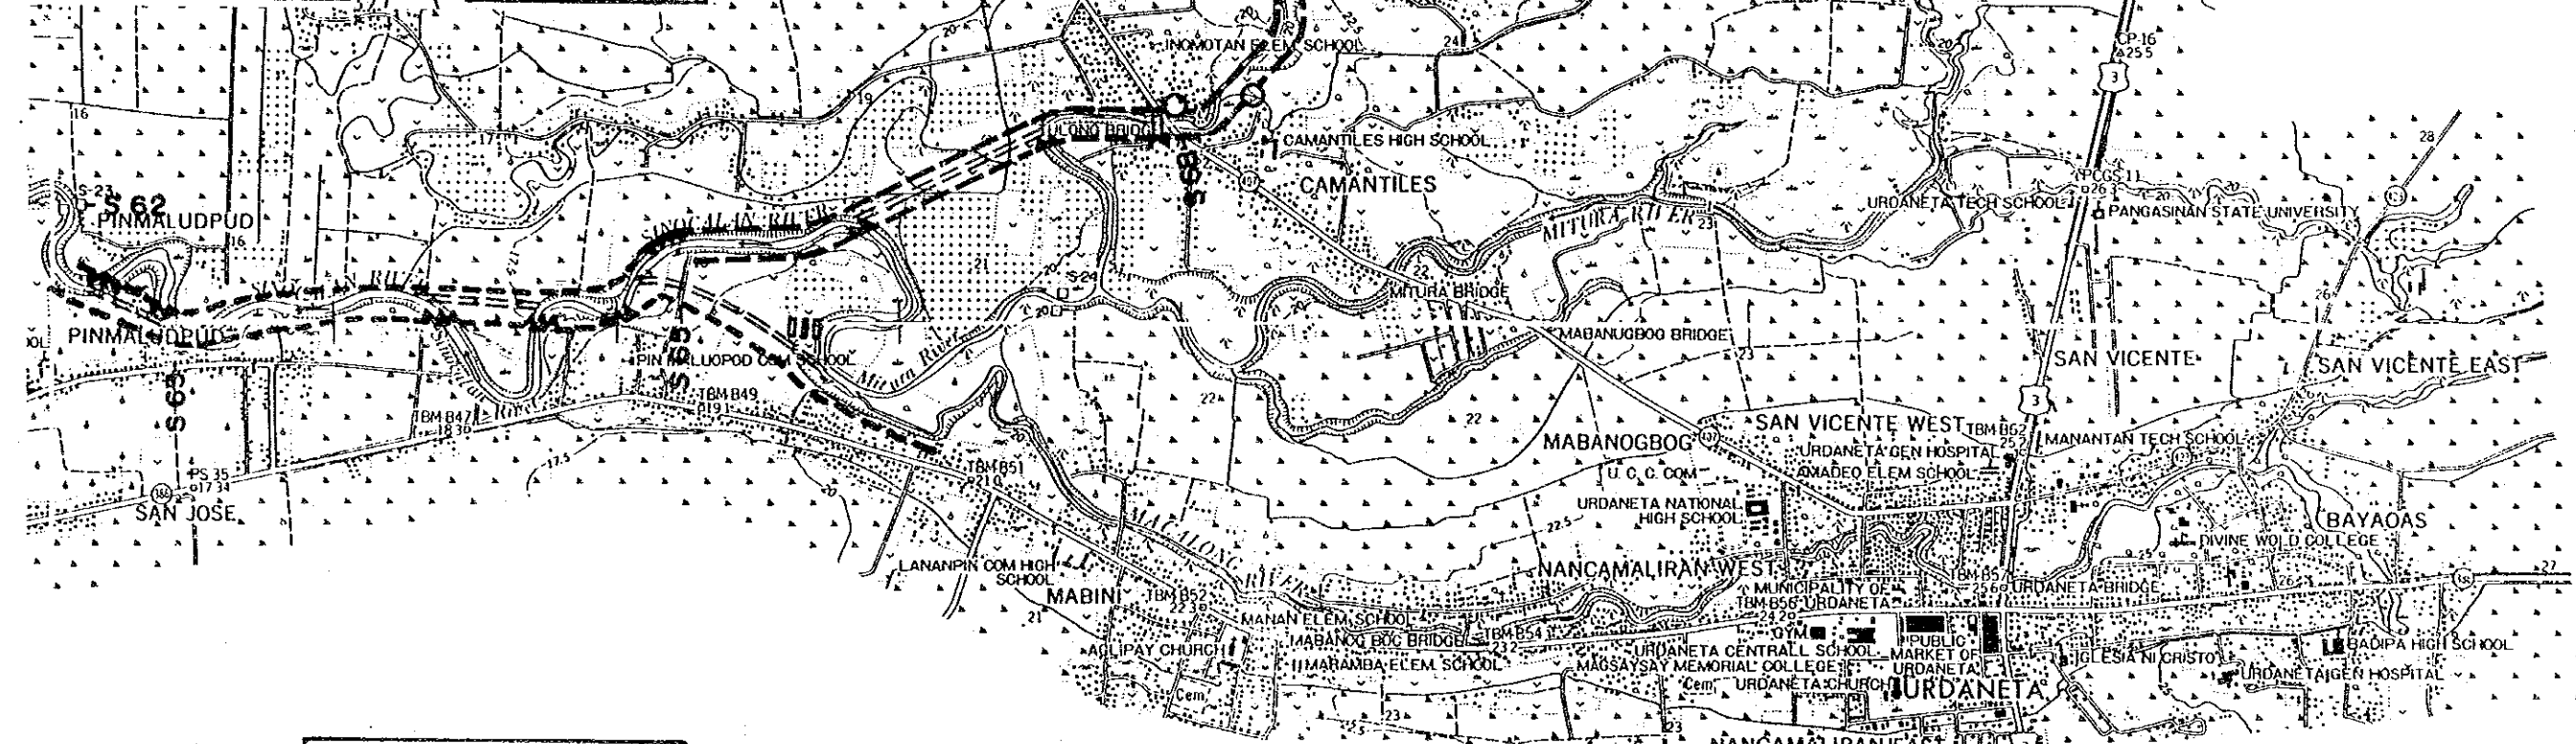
Pantar-Sinocalan川一般計画平面図・標準断面図 (4/4)
